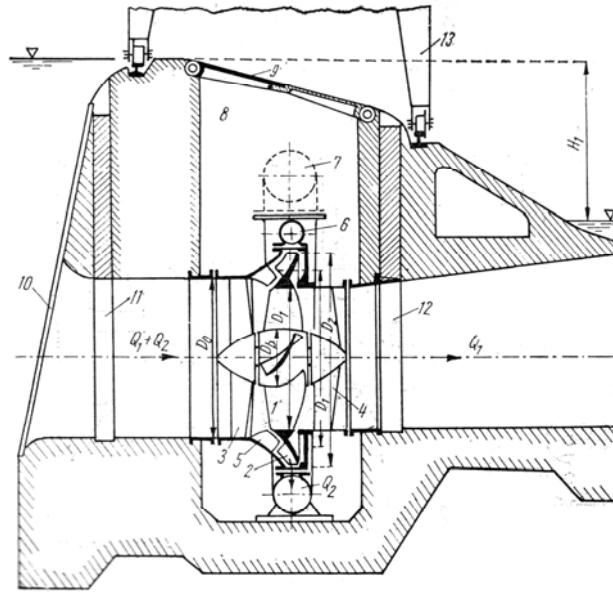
Turbotransformator cu turbină axială și pompă centrifugă
